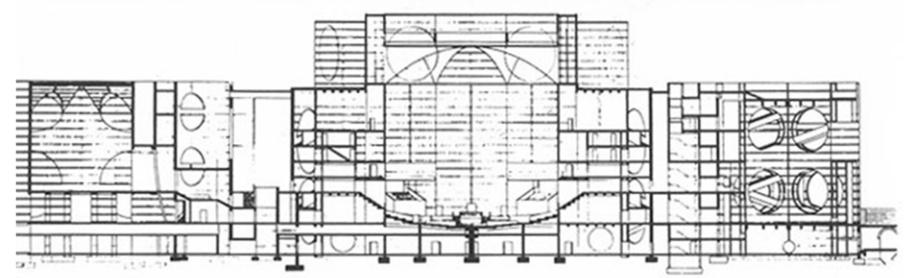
Alzado de la Asamblea Nacional de Dhaka, Bangladesh
